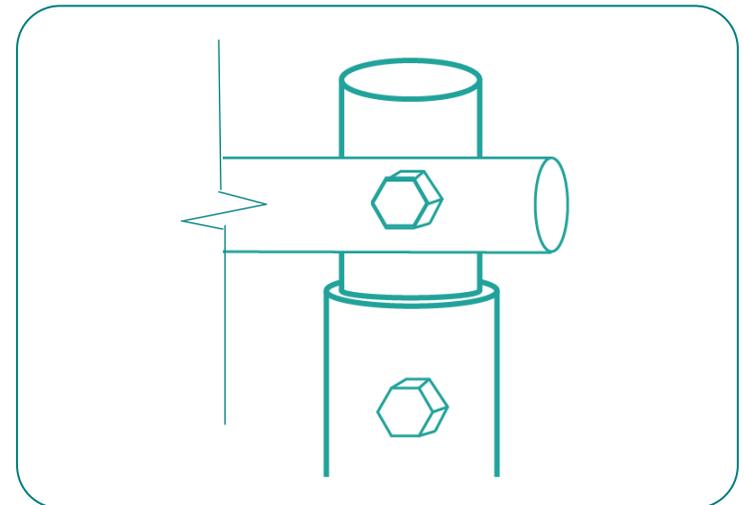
Ensamble 2 de columna con travesaño, elaboración propia.
